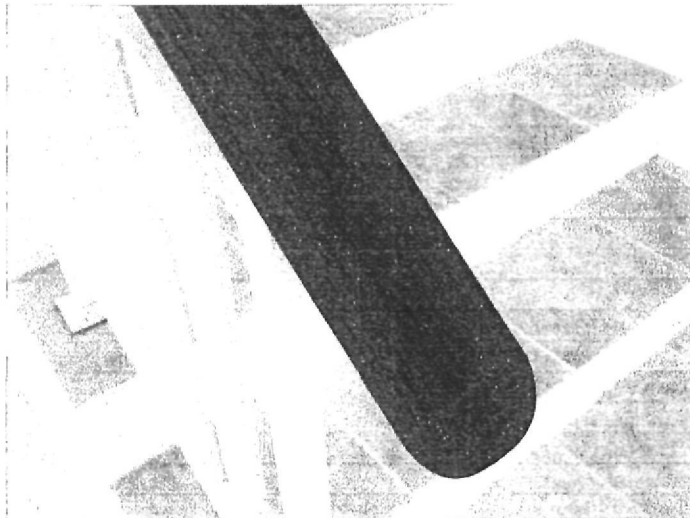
Aksesori pada "*handrail*" dalam keadaan baik
